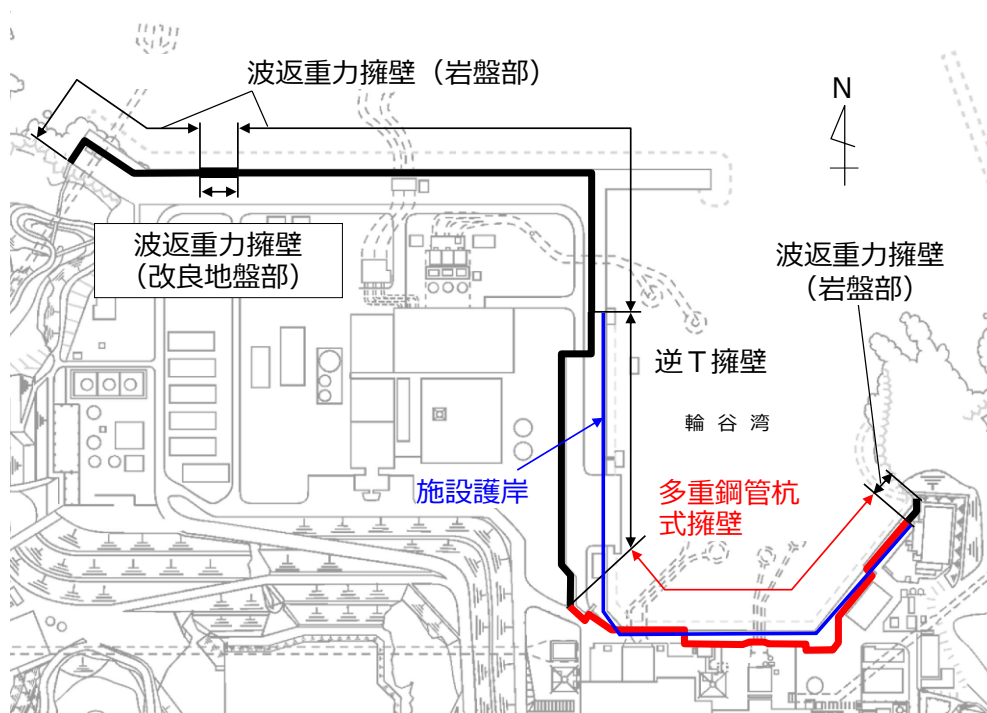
防波壁と施設護岸の配置（全体平面図）
